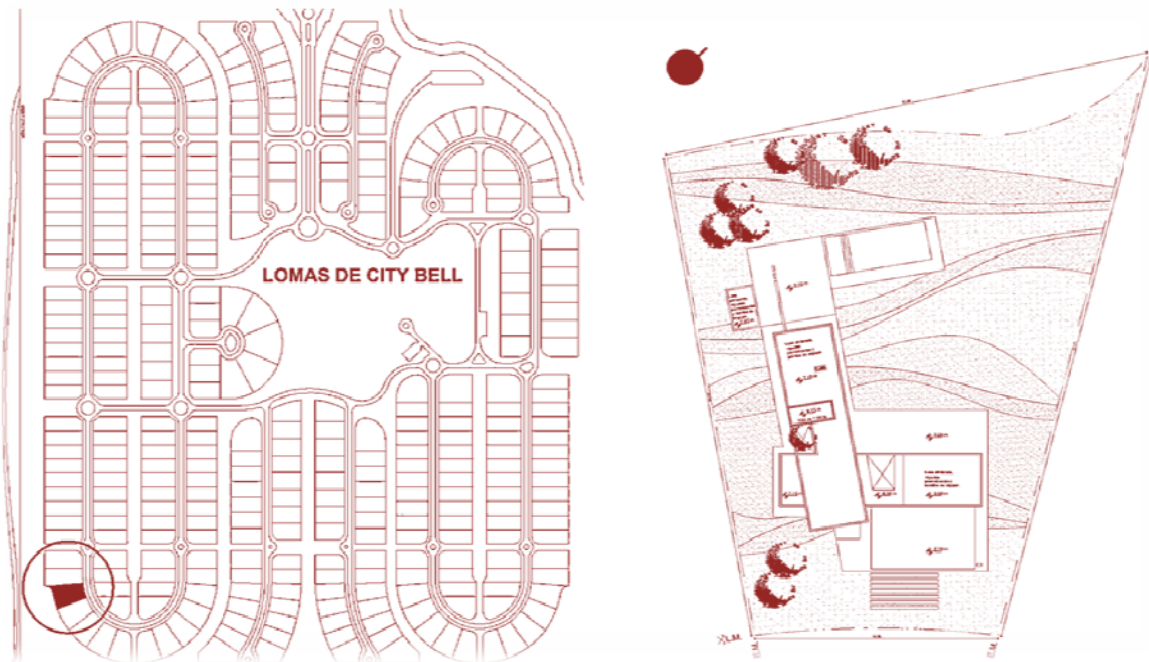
Masterplan del country con su respectivo parcelamiento, y plano de implantación de la obra a ser auditada. Fuente: elaboración propia.
